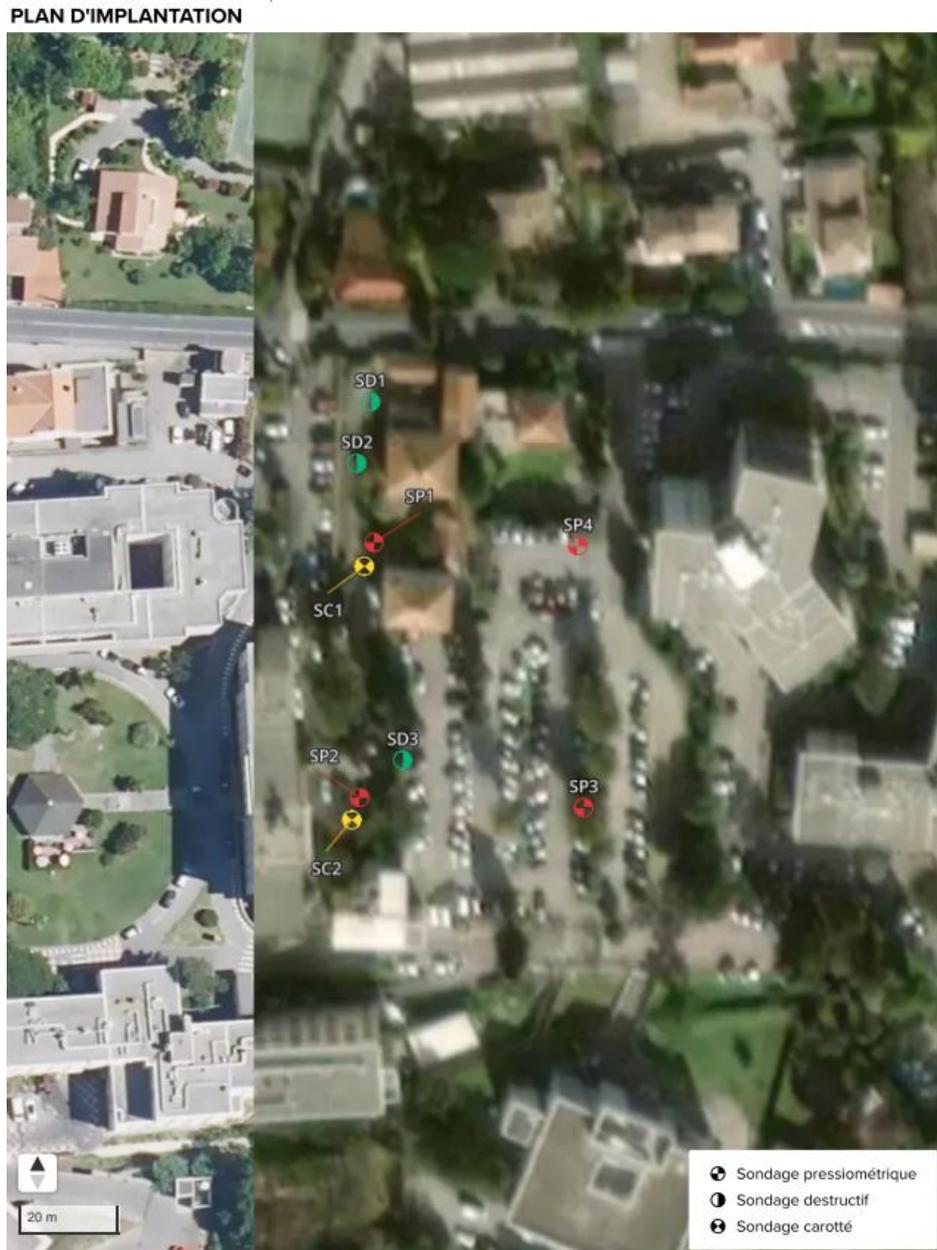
Plan d'implantation des sondages réalisés sur la zone d'étude (Source : Fondasol)
